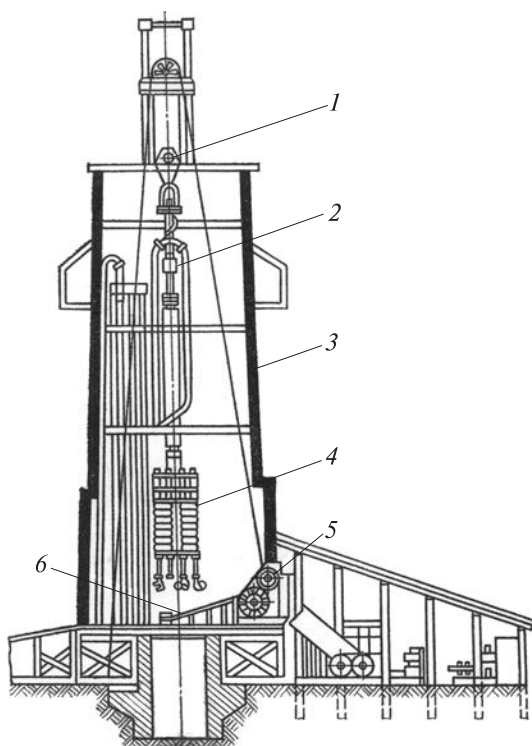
Схема бурової установки РТБ-2080: 1 — талева система; 2 — вертлюг; 3 — вежа; 4 — реактивний турбінний блок; 5 — бурова лебідка; 6 — ротор
